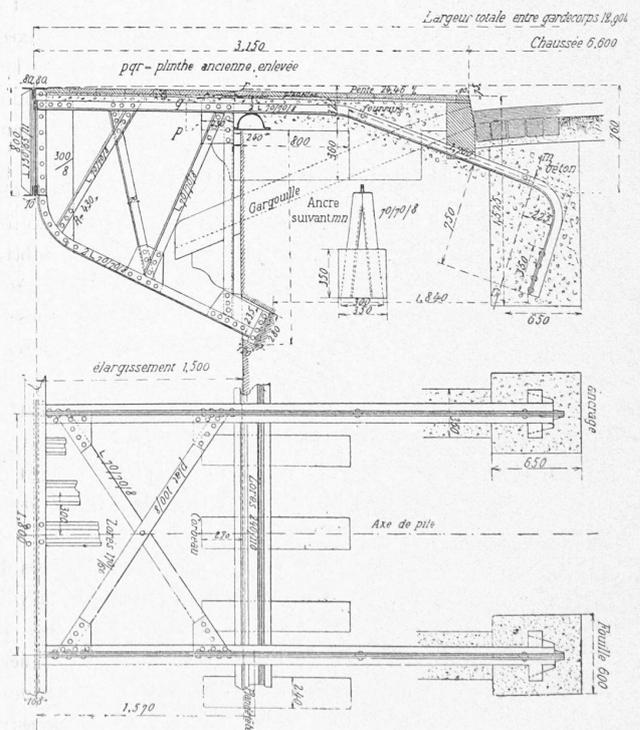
et 50. — Coupe contre une console et plan d'une paire de console.
